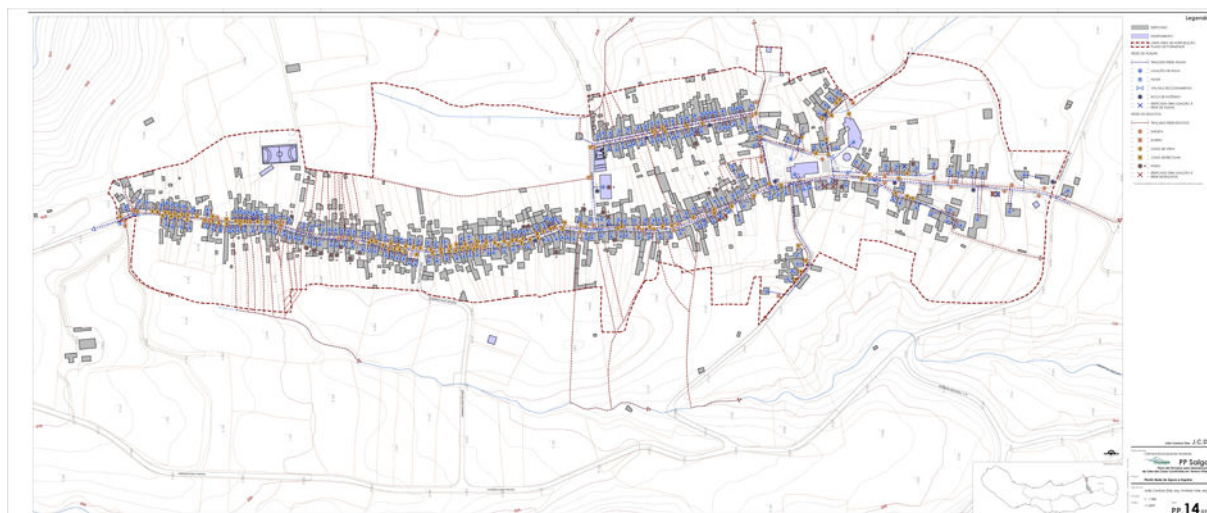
Planta Rede Águas e Esgotos (ver planta PP.14.07)
